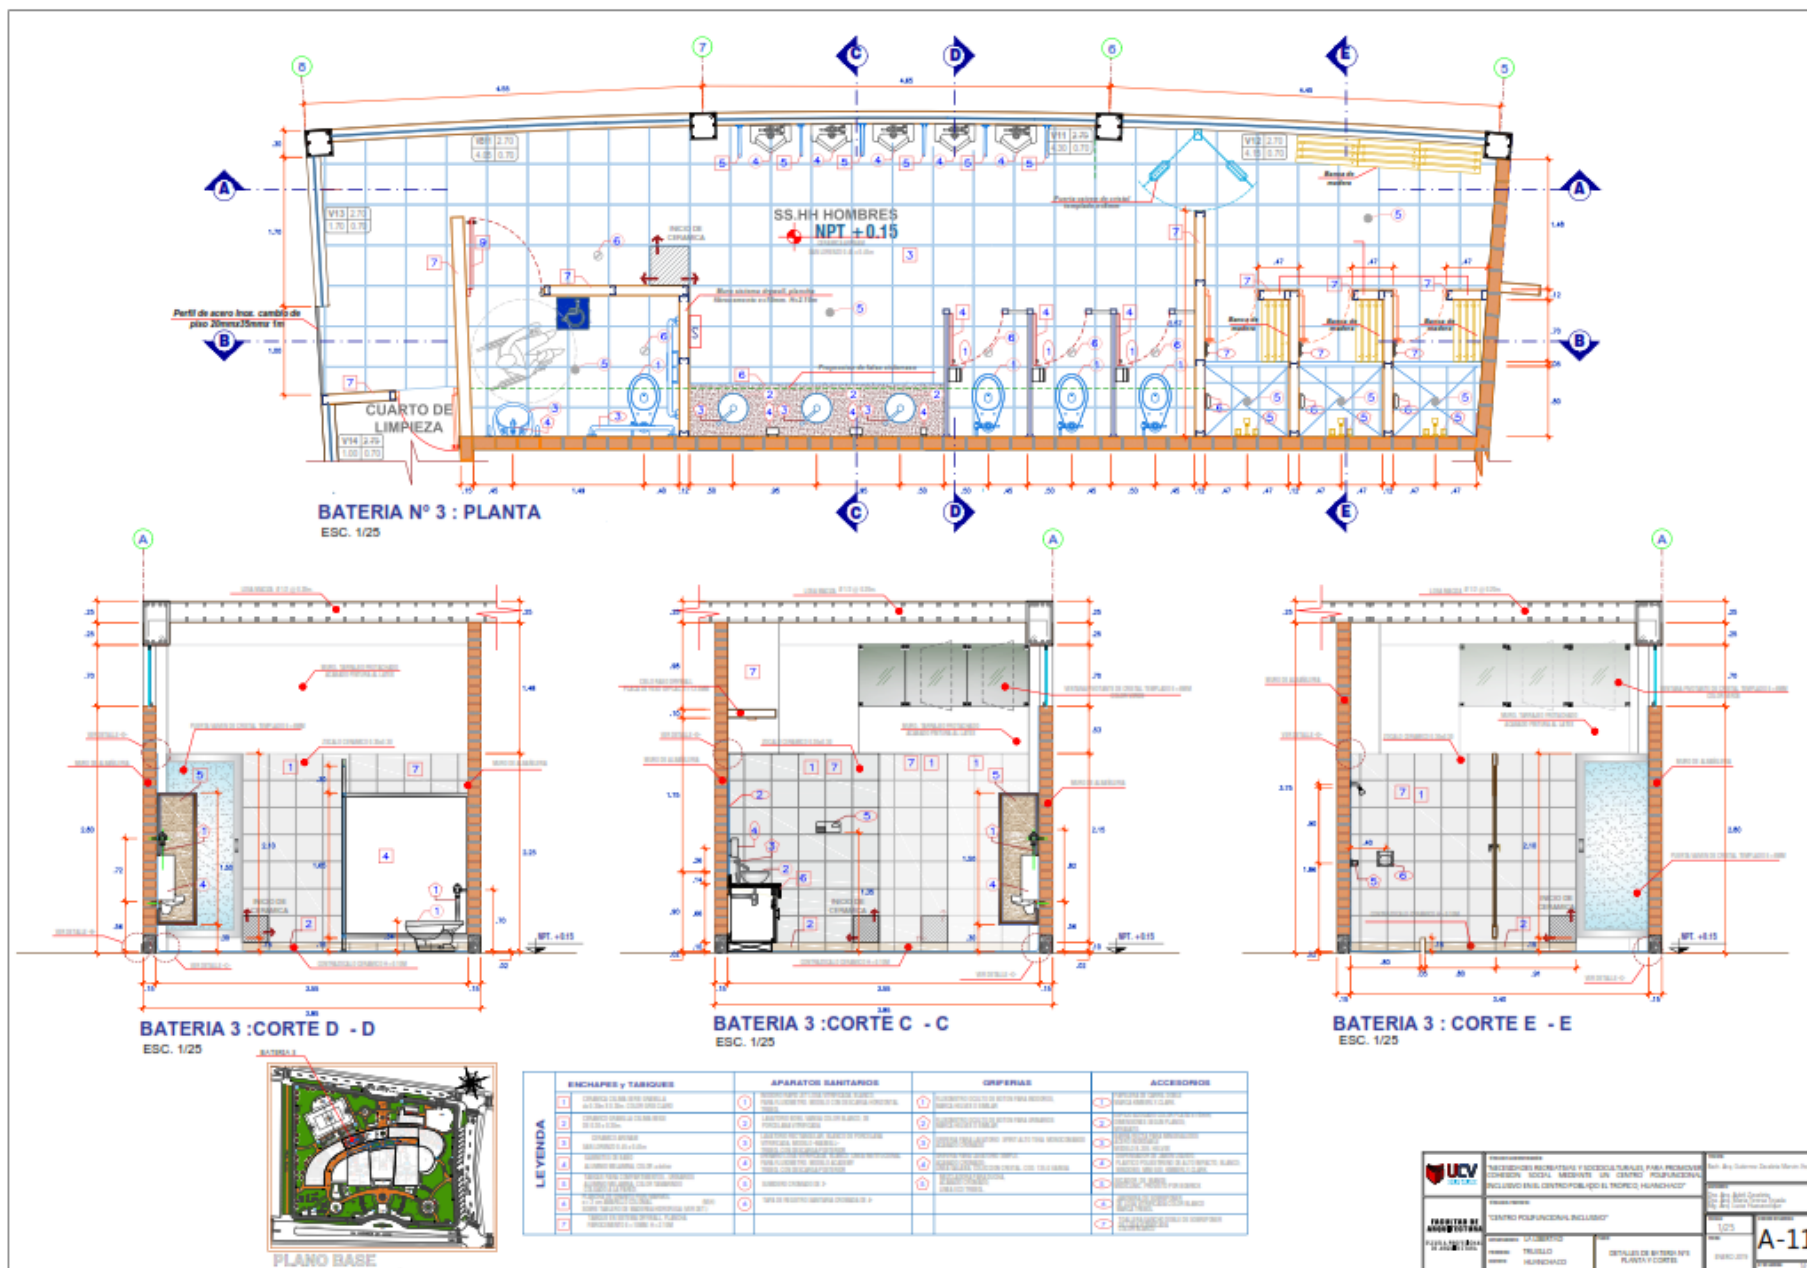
Desarrollo batería N° 3, planta y cortes: A-11. Fuente: Propia (2018)
